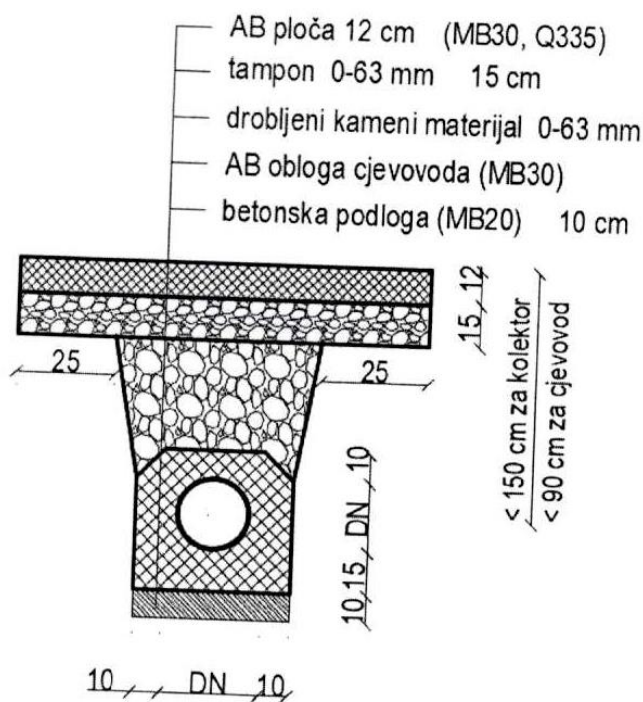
Detalj rova u trotoaru sa betonskim elementima
